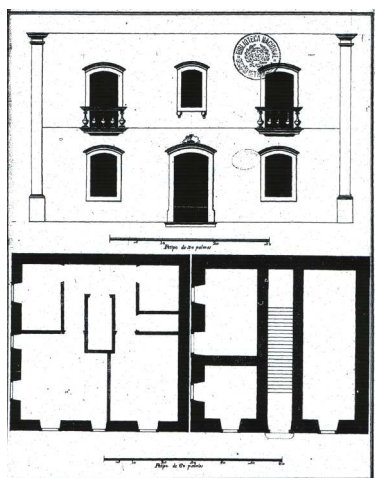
Planta Baixa da Casa de Câmara e Cadeia da Vila de São José – 1762
